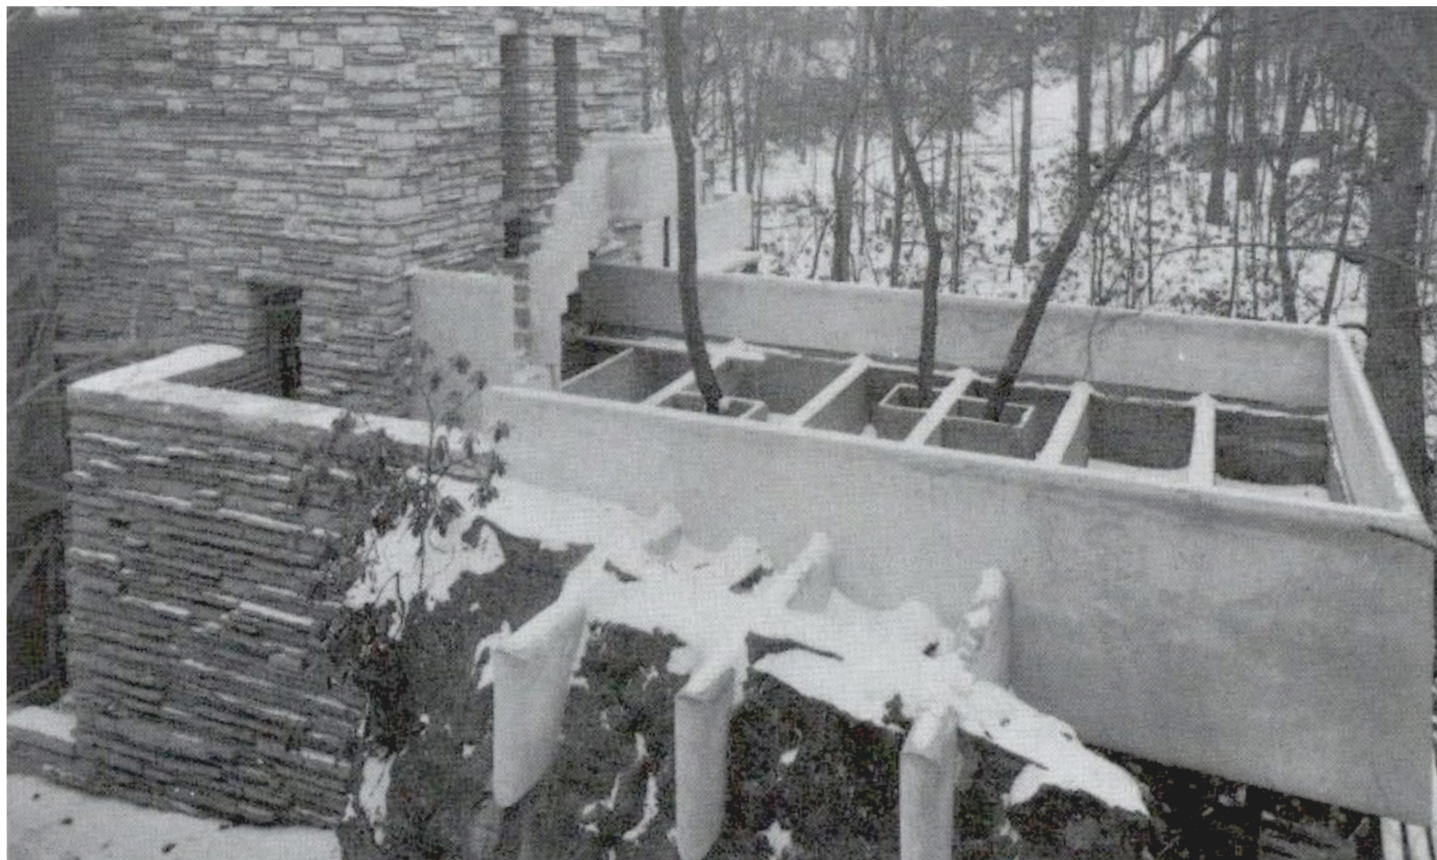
Construcción de la terraza privada de Edgar Sr. Kaufmann, 1937
